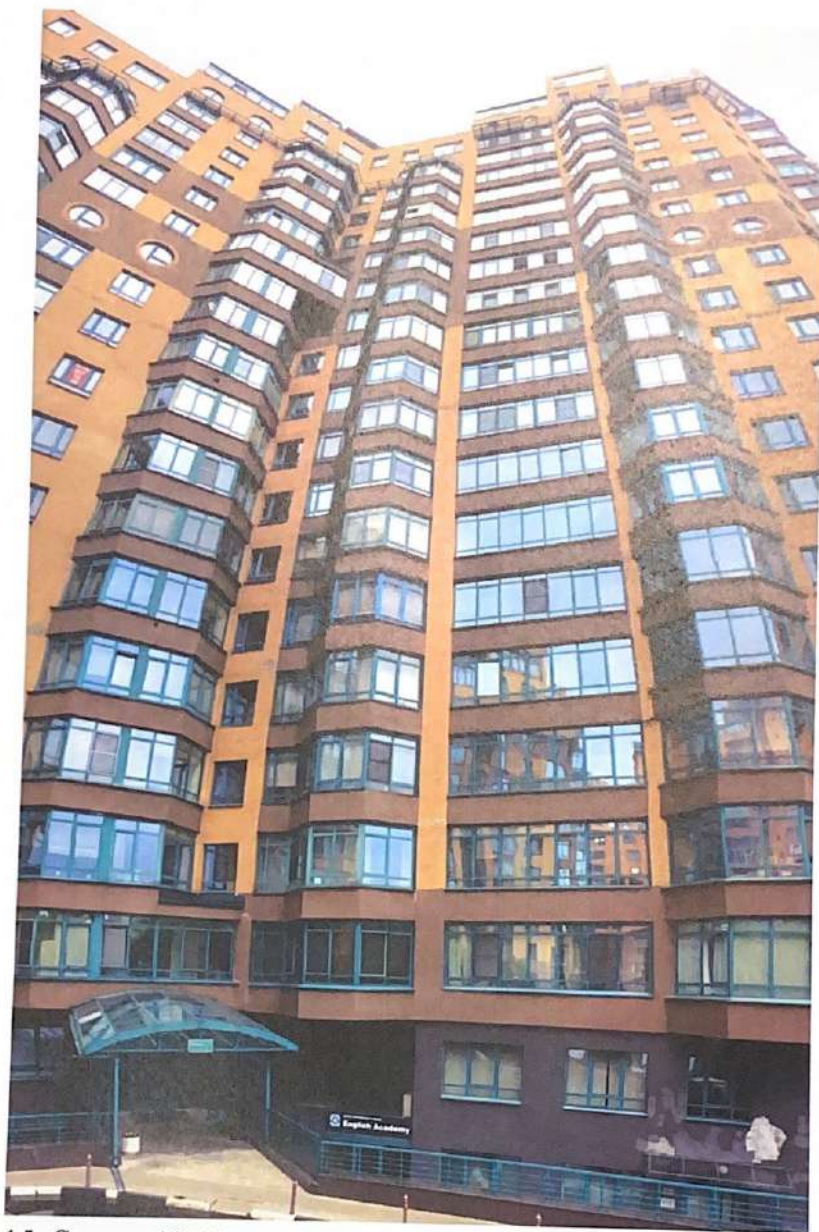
Секция 10. Дворовой фасад. По исполнительной схеме Фасад 3.
